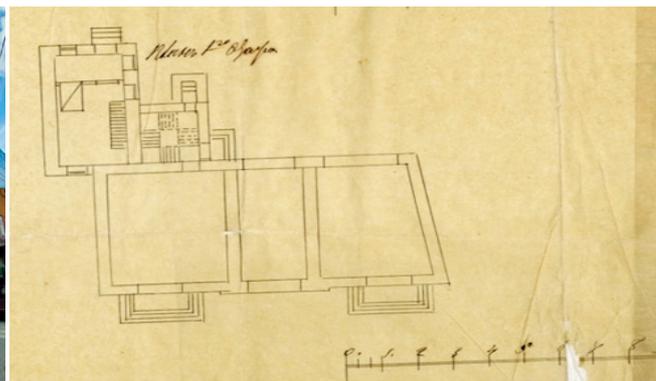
План фасада проекта дома Денисова. 1900⁸Рис. 12. Проект реконструкции. 1892¹⁰
